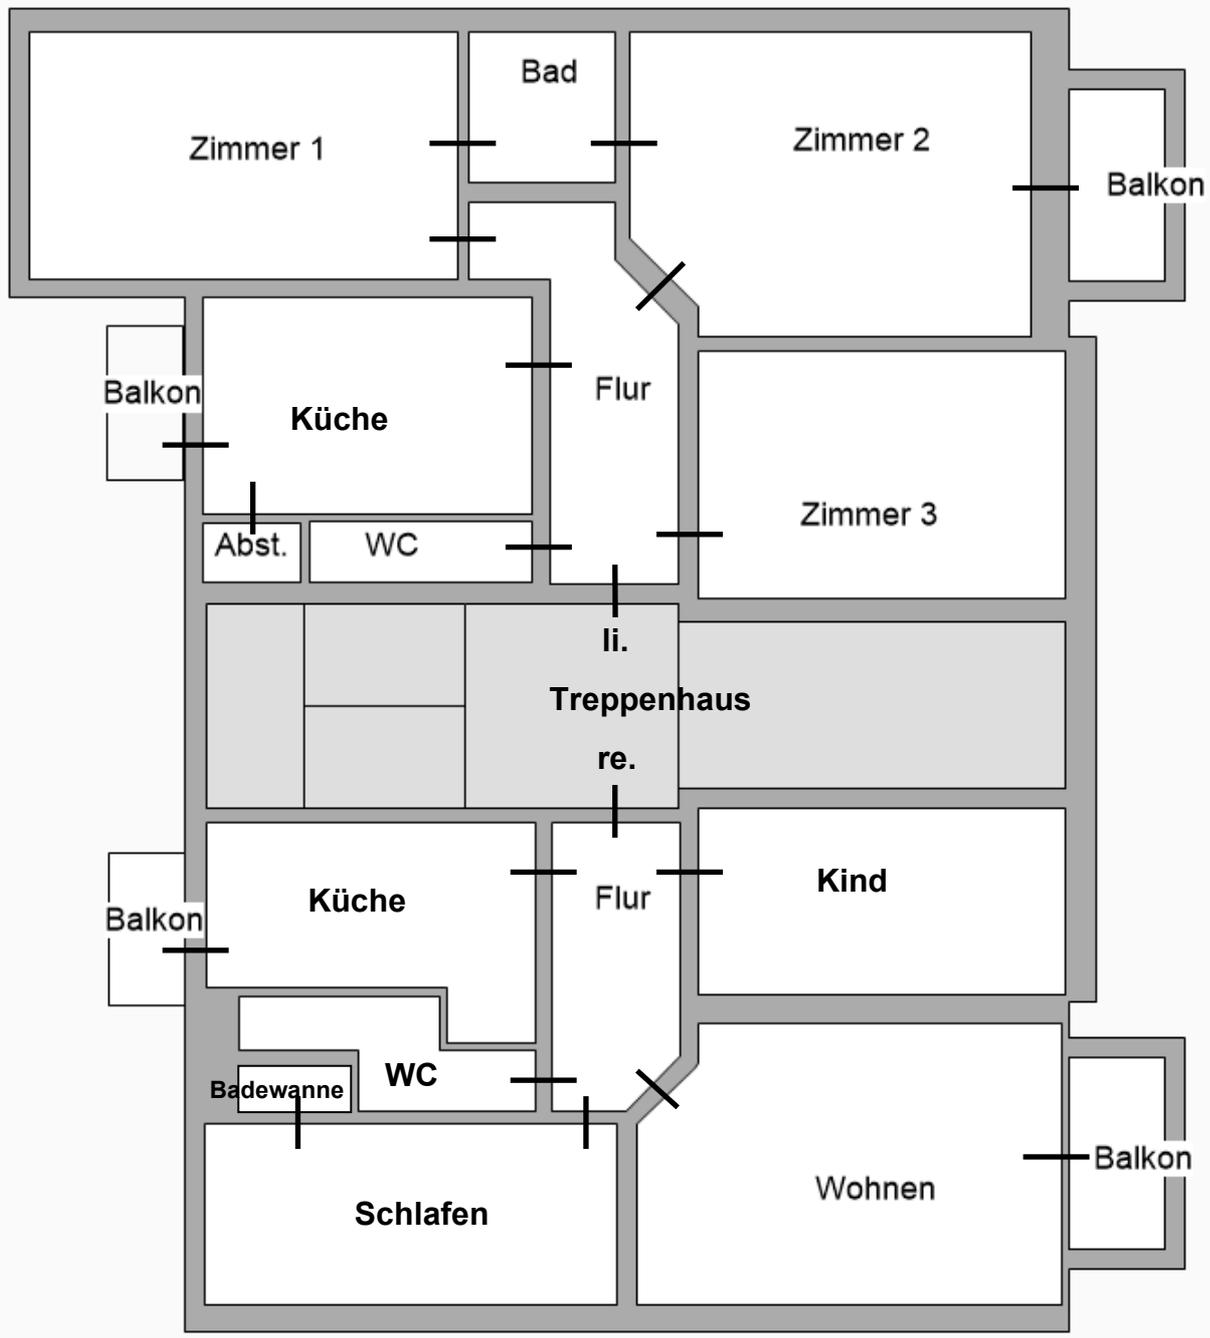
Grundrisssskizze (ohne Maßstab) des SV (grob schematische Raumaufteilung); Hochparterre (ohne Nebengebäude und Garagen)
